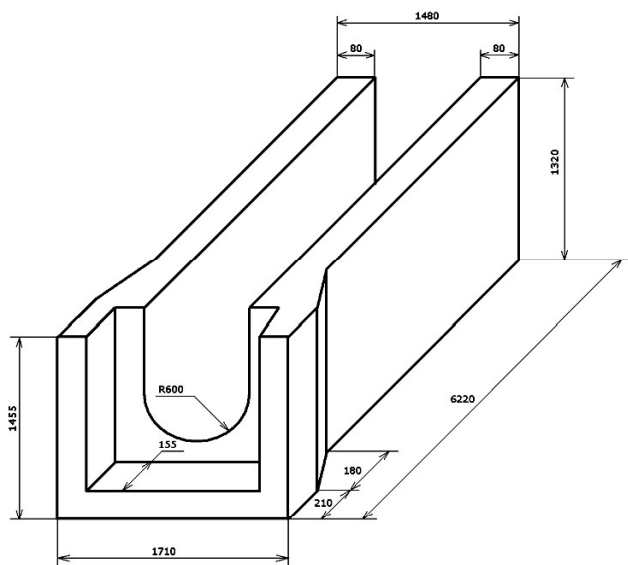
Труба лотковая железобетонная ЛТ 60-16
